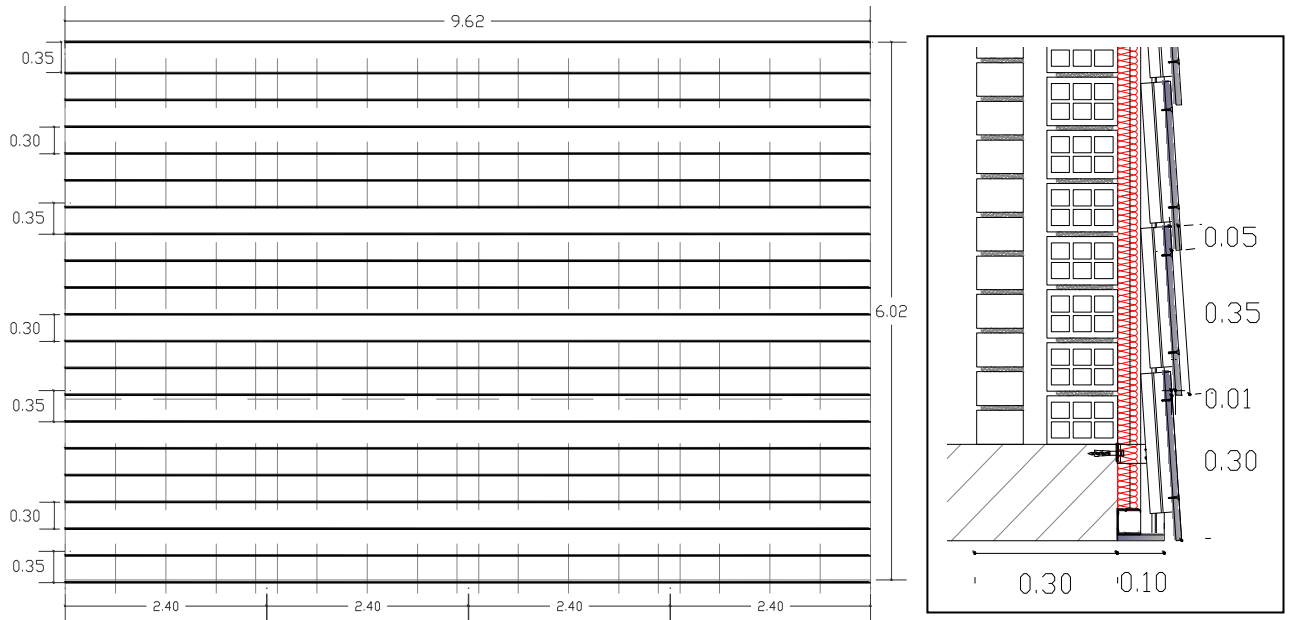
Alzado y sección de (FVL) configuración (Fd) Lamas de 350mm solapadas 50mm longitud visible 300mm con distancia entre lama y lama de 10mm alzado en fachada y detalle en sección (D)
